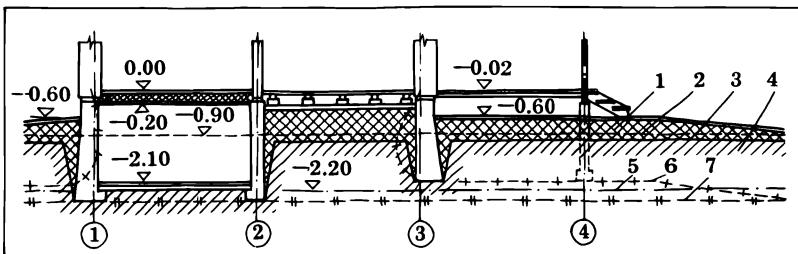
Поперечный разрез по подвалу и фундаментам при повышении планировочной отметки земли за счет насыпного грунта
